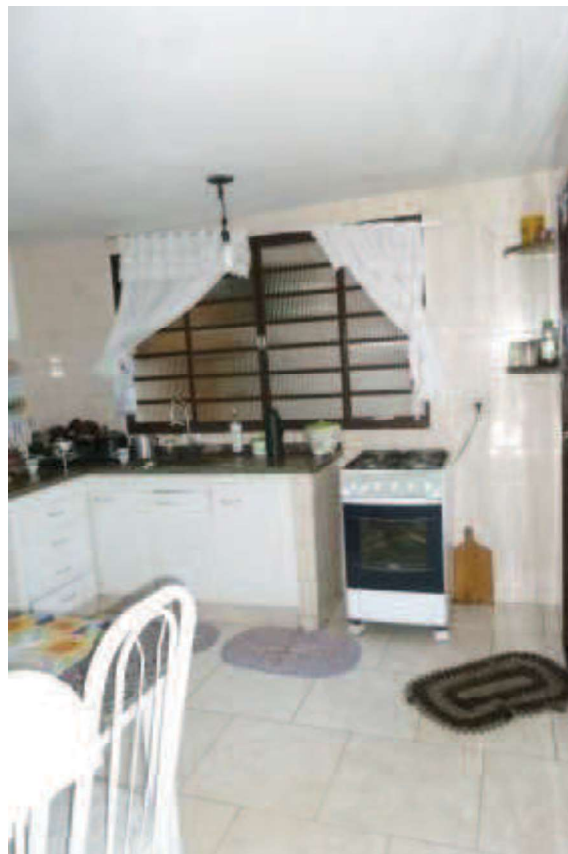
Vista da cozinha com laje de forro, piso cerâmico em bom estado de conservação.
